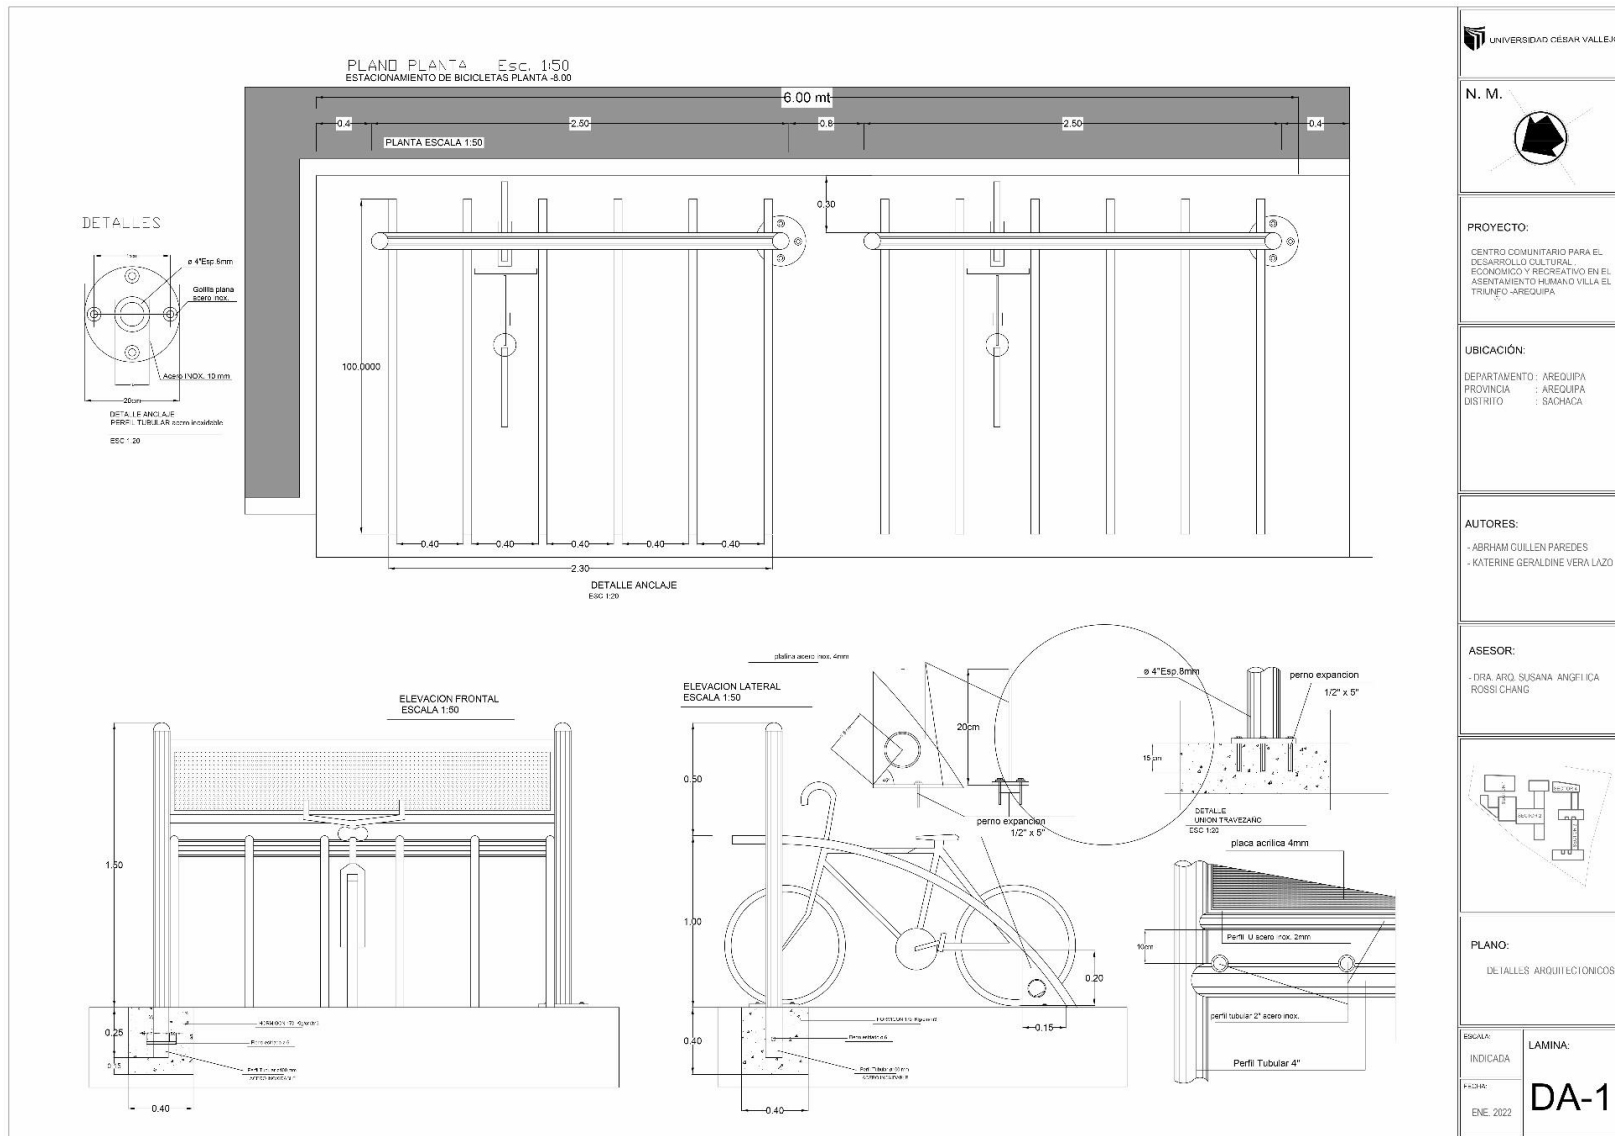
Plano de Detalles Arquitectónicos (Estacionamiento de bicicletas) - Elaboración propia
